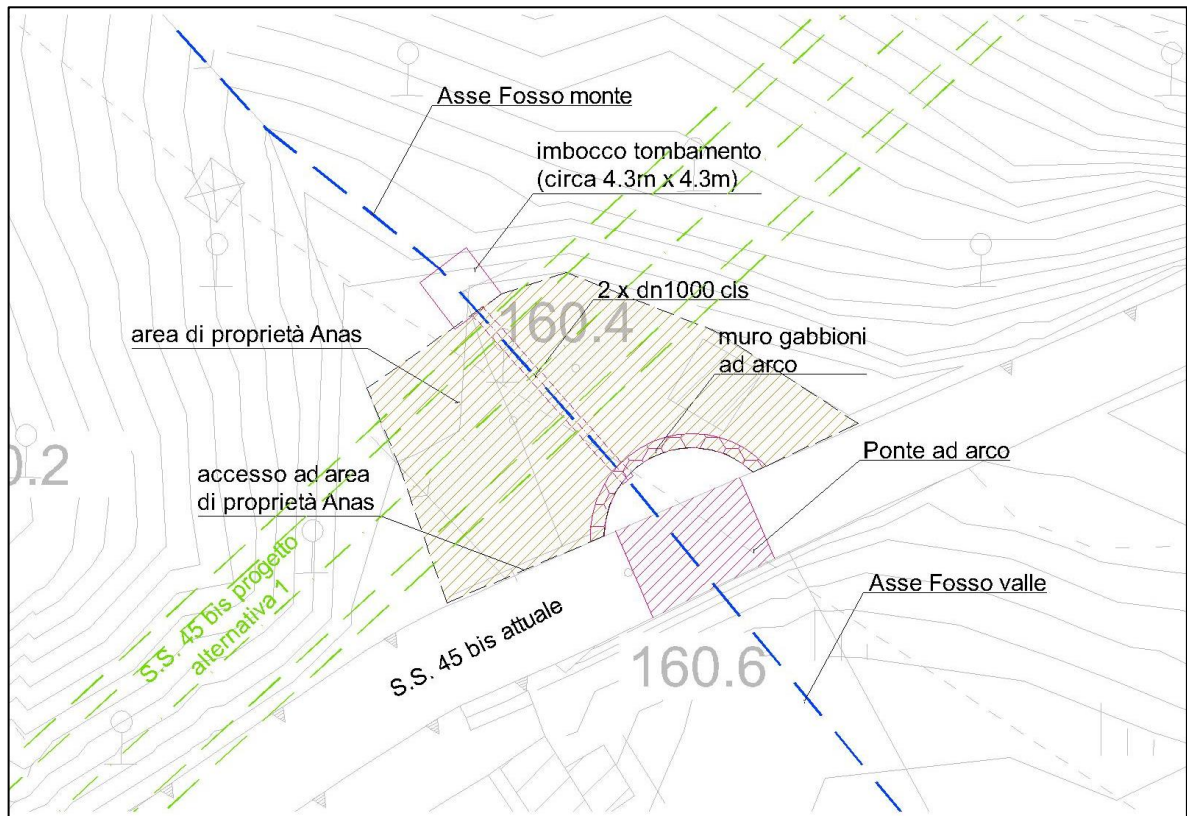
Ricostruzione attraversamento attuale sotto la SS45 bis - pianta
